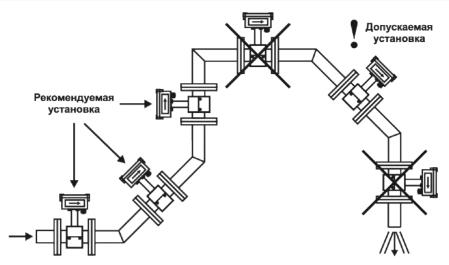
Рекомендуемая установка расходомера в трубопровод
